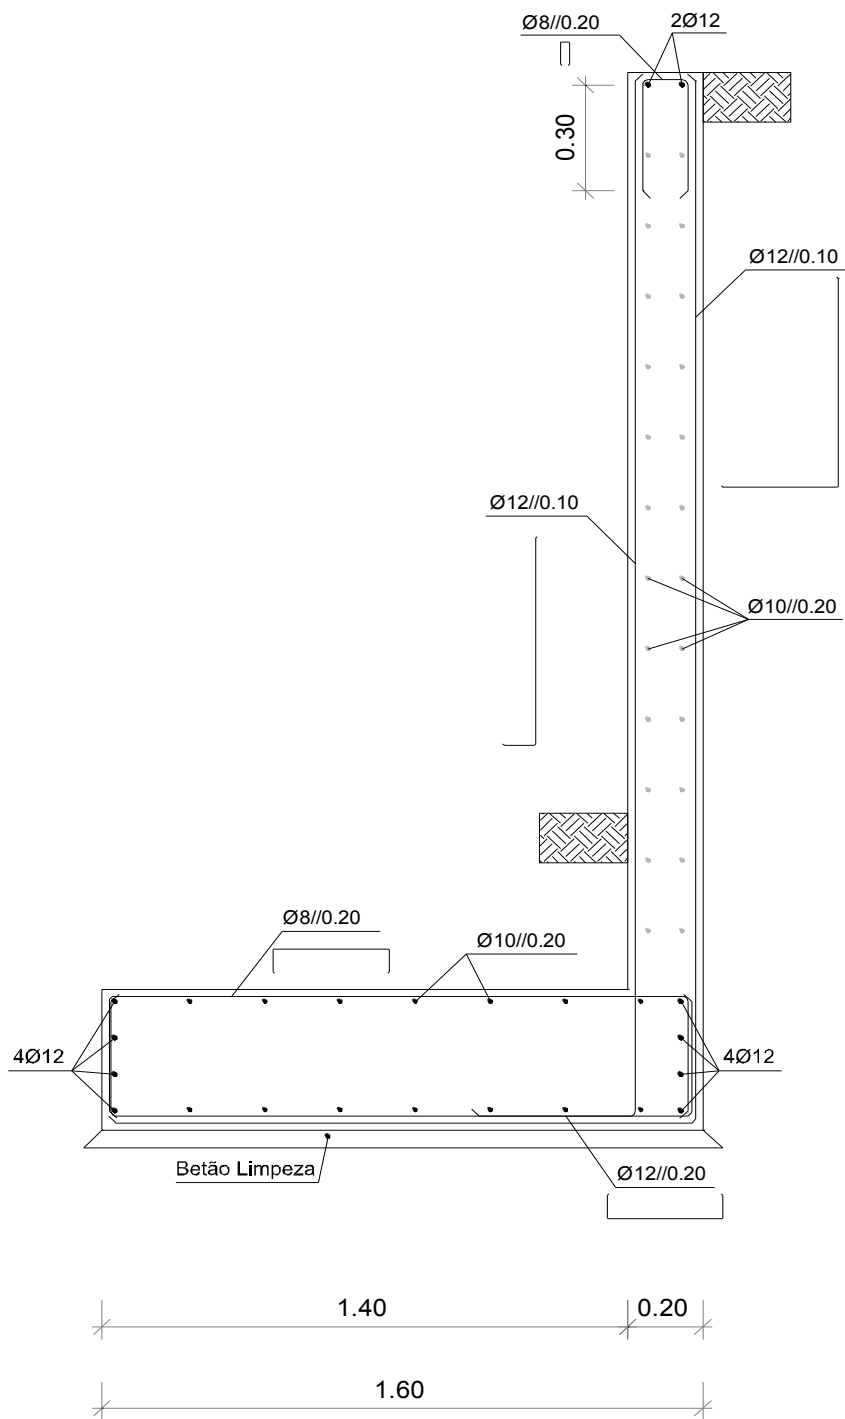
CORTE TIPO DO MURO DE SUPORTE MS3(A) (AUTOCAD)
